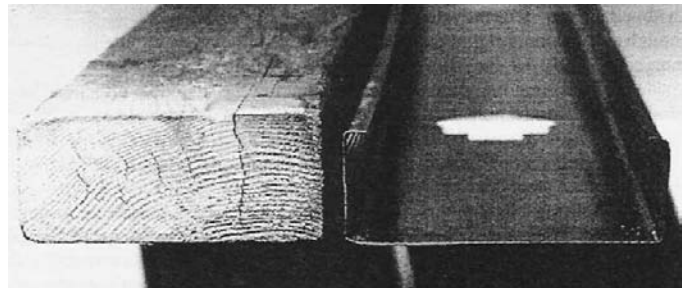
Perfiles estructurales de madera y acero galvanizado. (Fuente: Robert Scharff).
